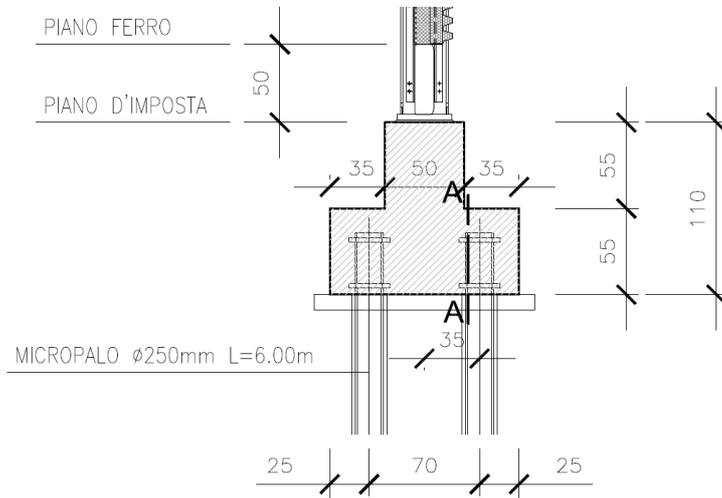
sezione fondazione di linea BFA (BA16-BA17)
